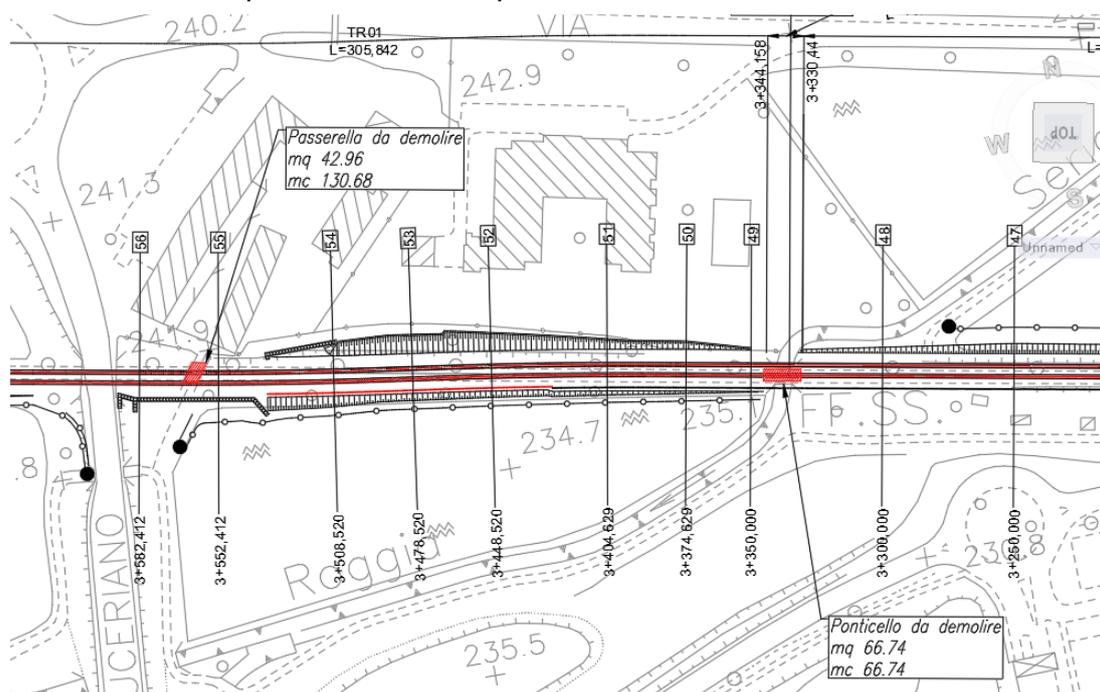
stralcio planimetrico di inquadratura da planimetria di progetto
